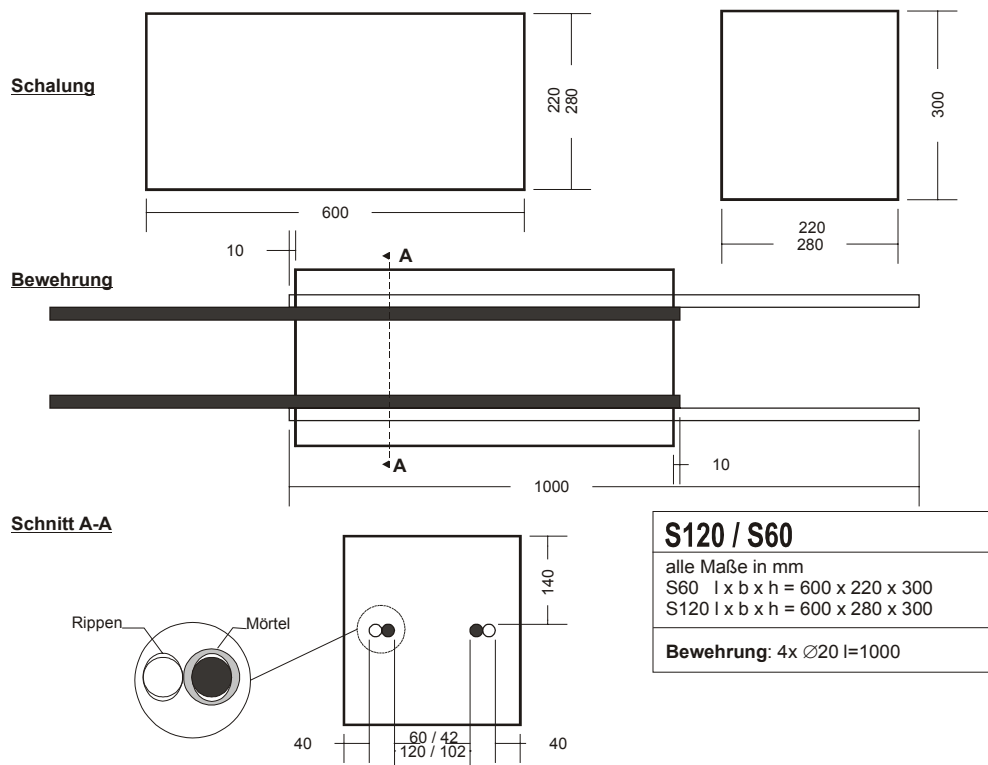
Schal- und Bewehrungsplan für Dehnkörper ohne Querbewehrung
